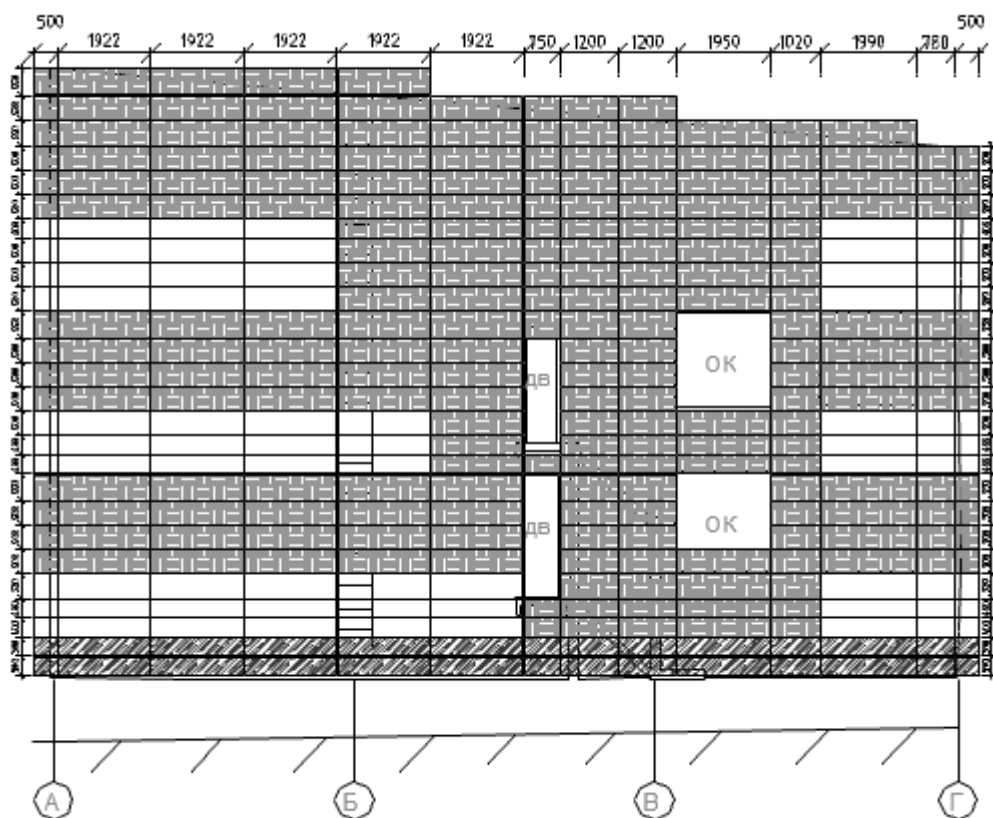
Раскладка кассет на фасаде в осях А-Г.
